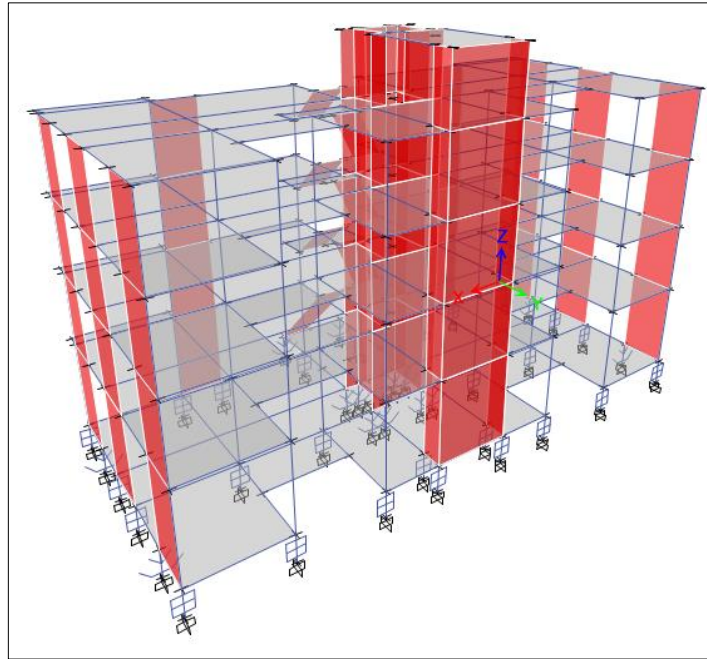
Vista conjunta posterior y lateral del modelo estructural 3D con aislación
